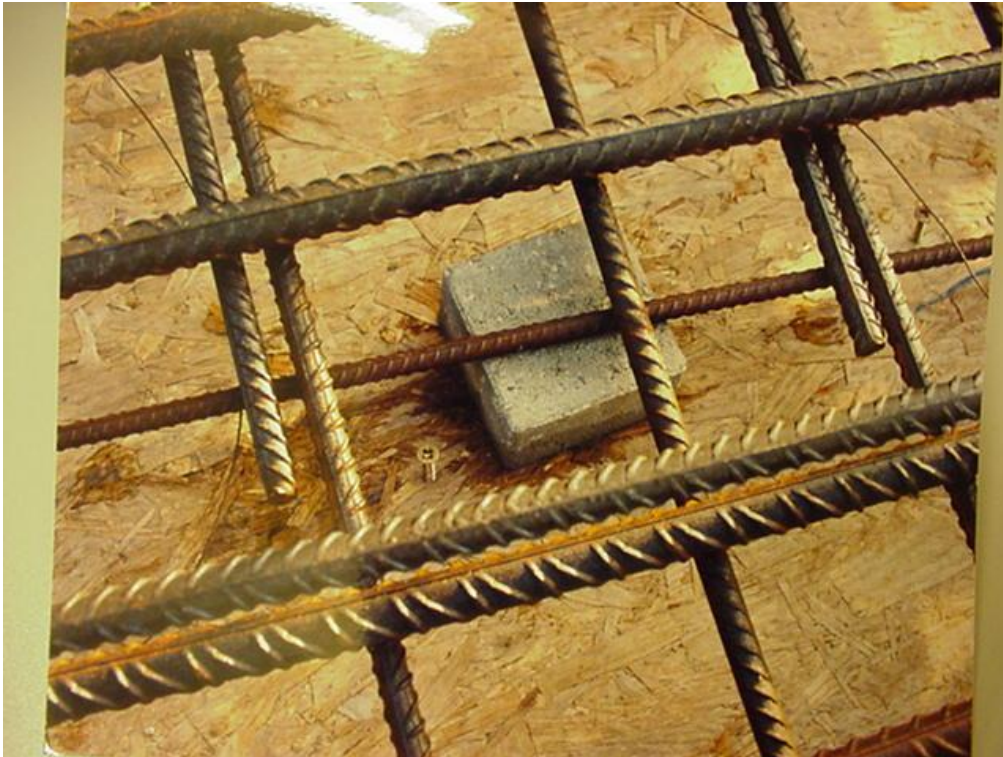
Eerste laag wapening op borgstaven en stelblokken
